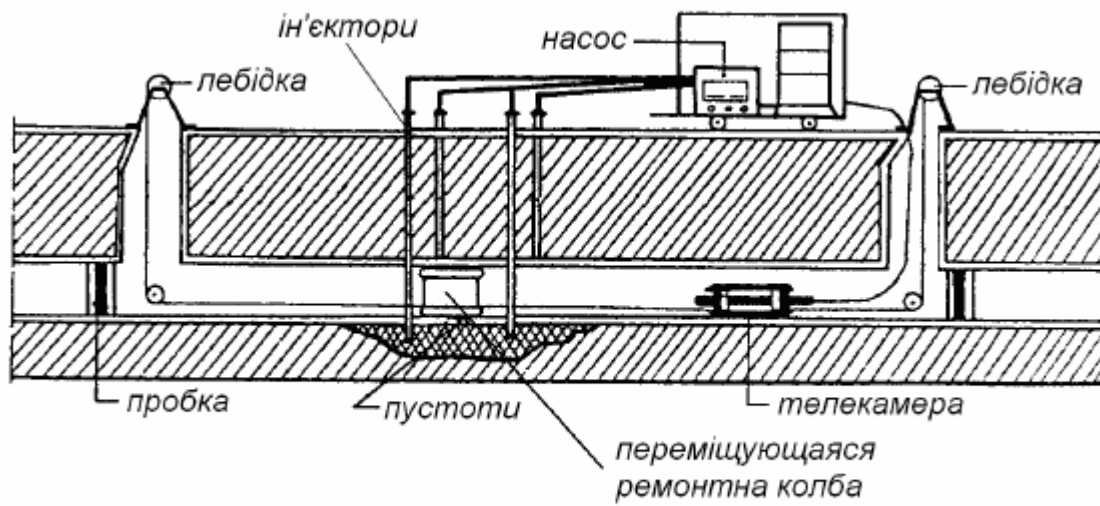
Схема ін'єцювання зовнішньої поверхні трубопроводу
